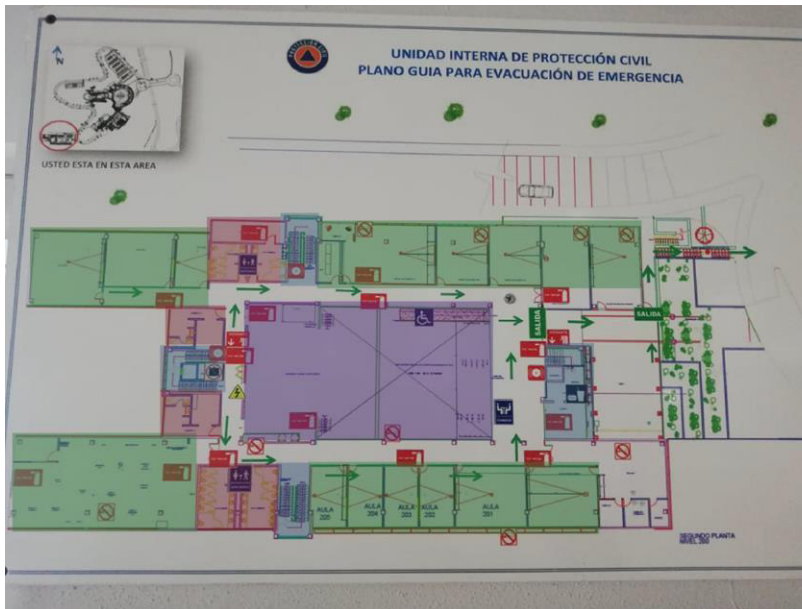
Segunda Planta del Edificio en DCEA. Propia 2021.
